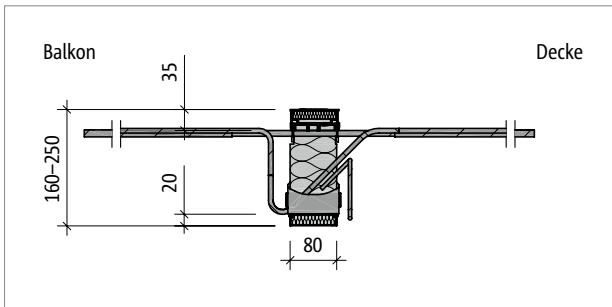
Schöck Isokorb® T Typ K-ID-M3: Produktschnitt
